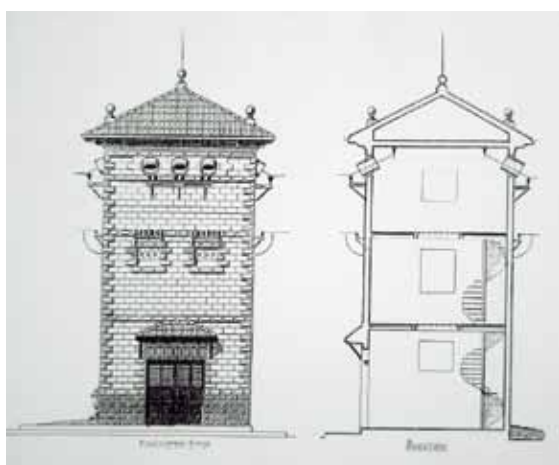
Transformador realizado con bloques de hormigón, La Braña, Gijón. (D)
